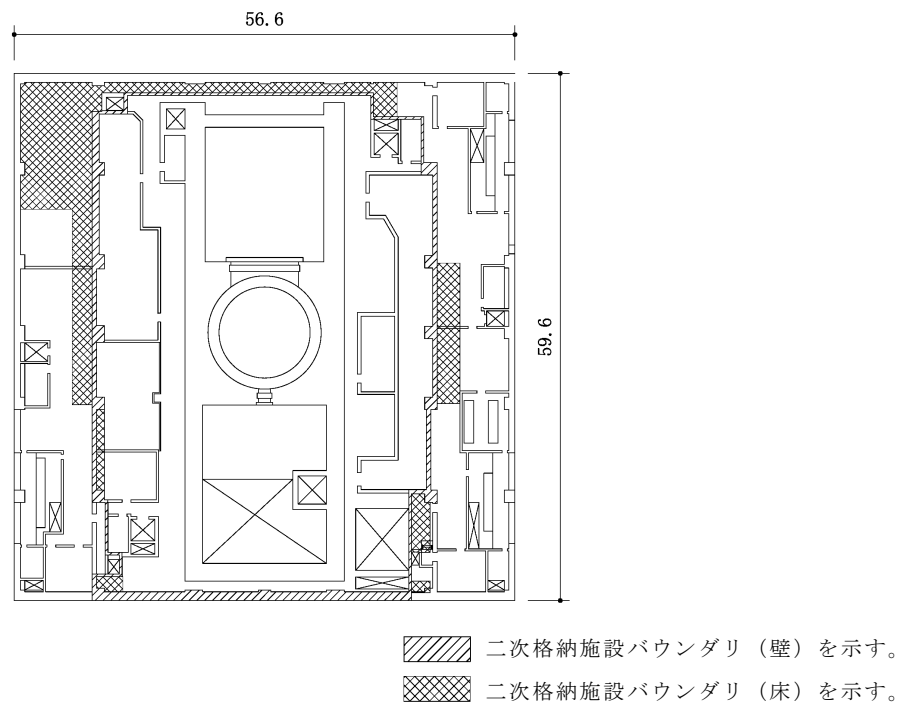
原子炉建屋原子炉区域（二次格納施設）の範囲の平面図
